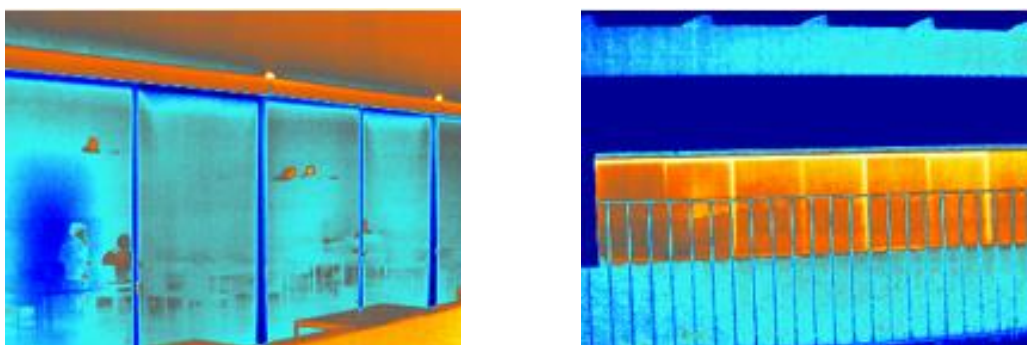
Infiltrações em fachadas com sistema ETICS
